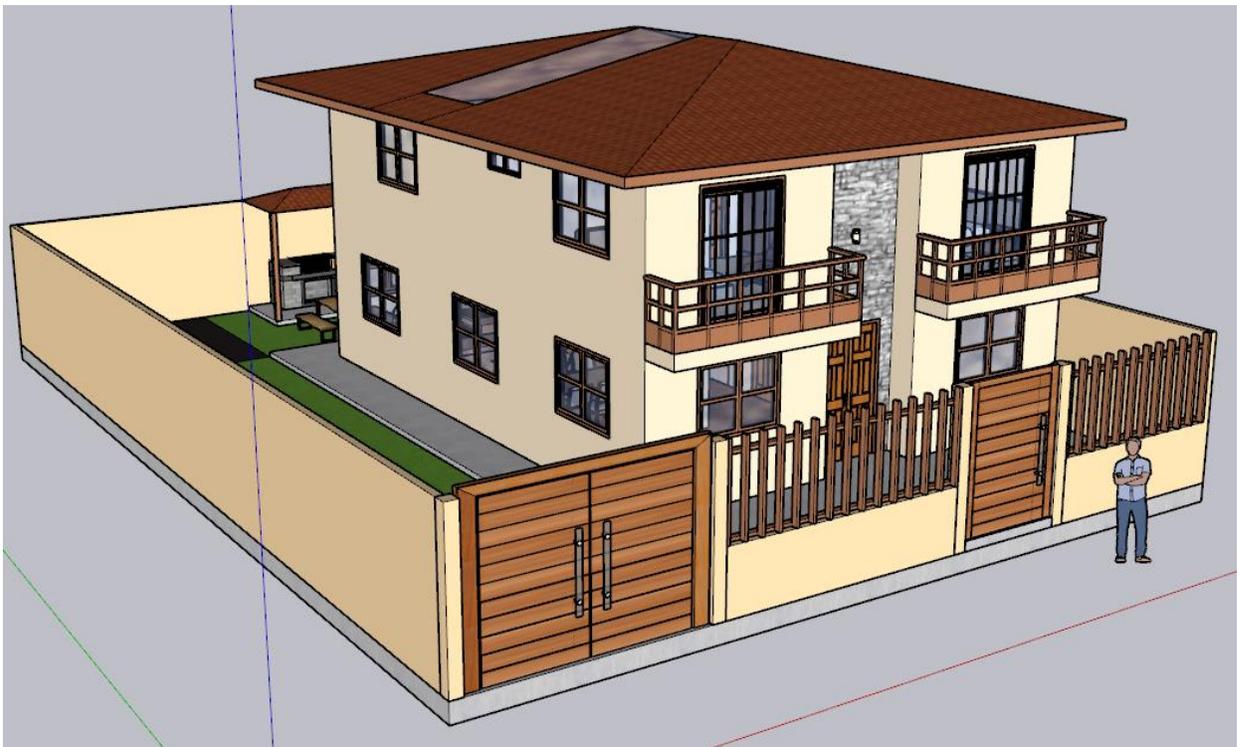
Modelo arquitectónico de propuesta. Vista perspectiva en planta de planta baja
